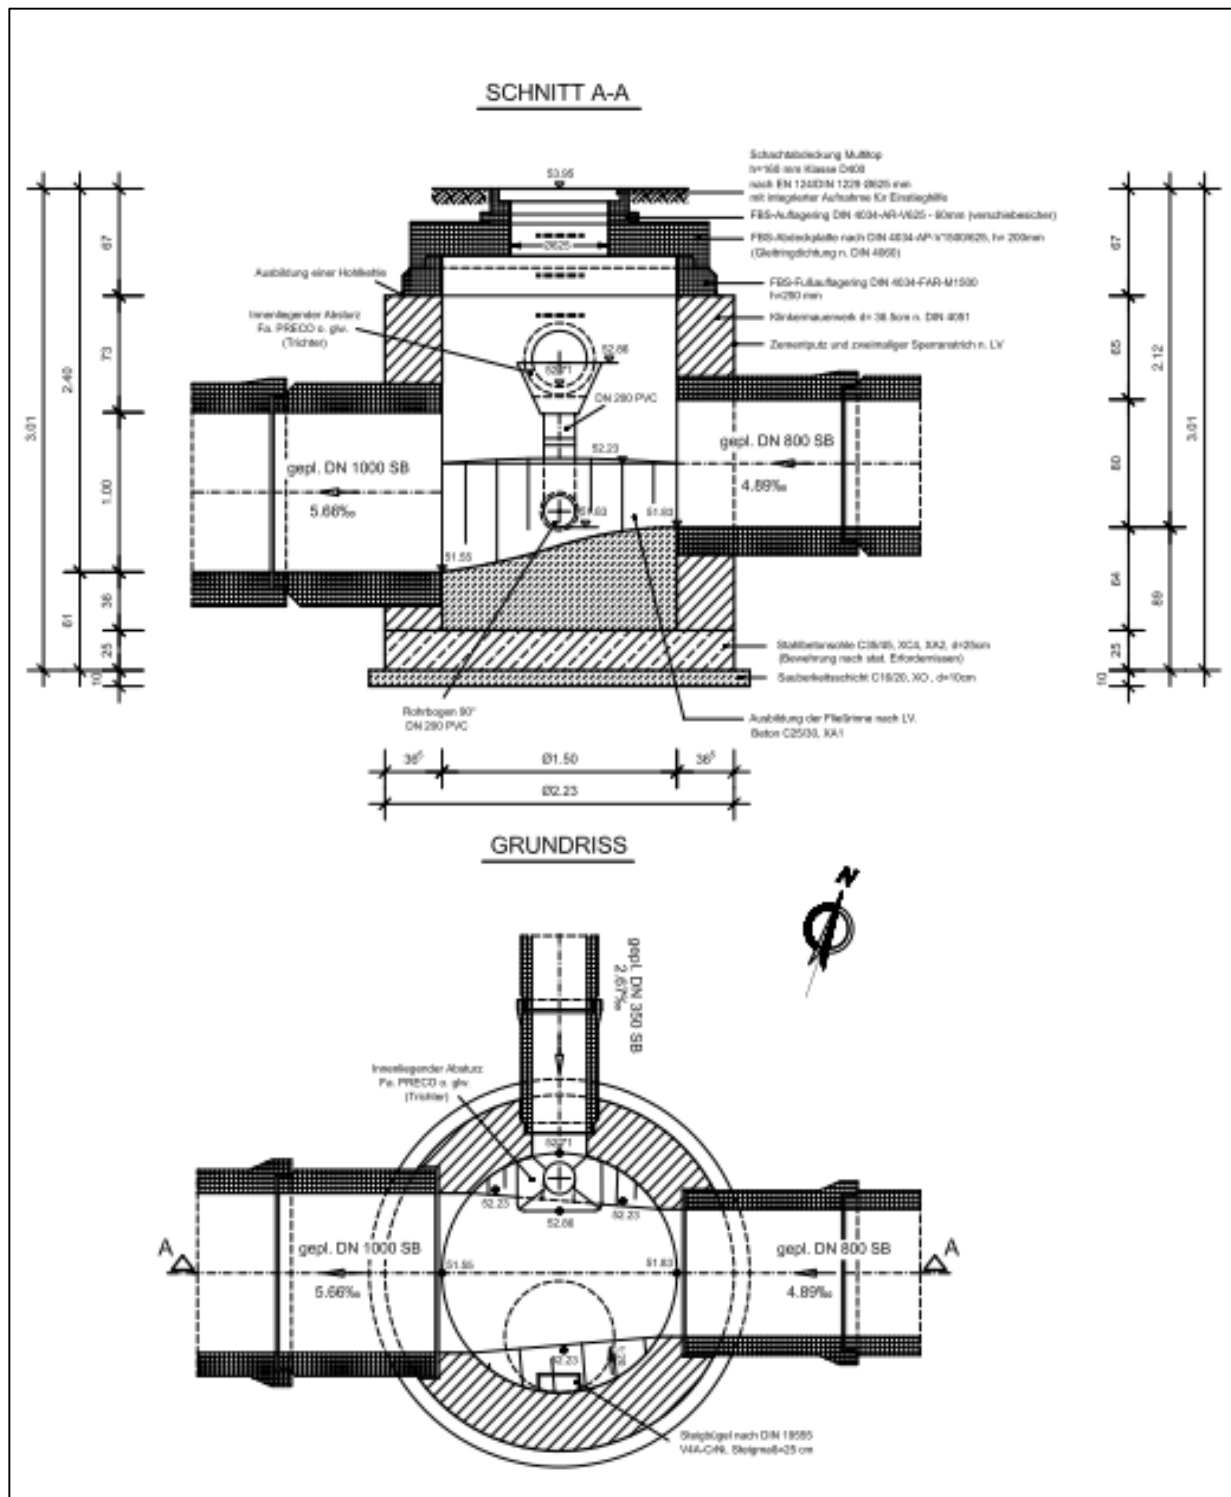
Schachtbauwerk R1032N, Schnitt und Grundriss
